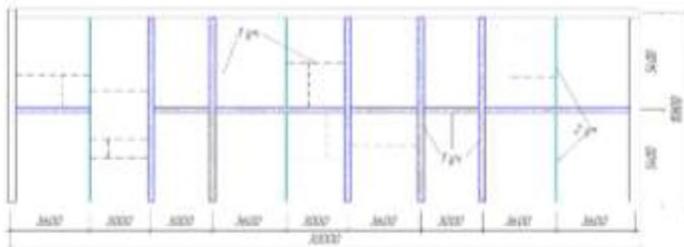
План здания, для всех вариантов контрольной работы №1
